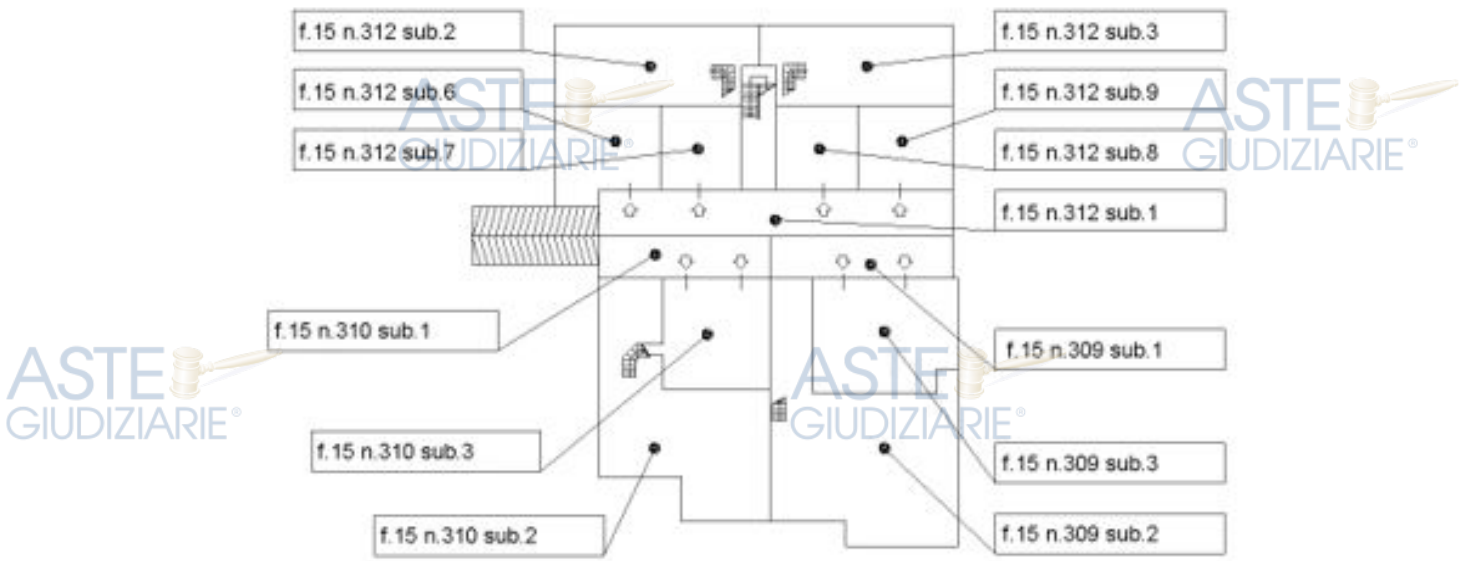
Elaborato planimetrico prot. n. TO0376726 – piano interrato
